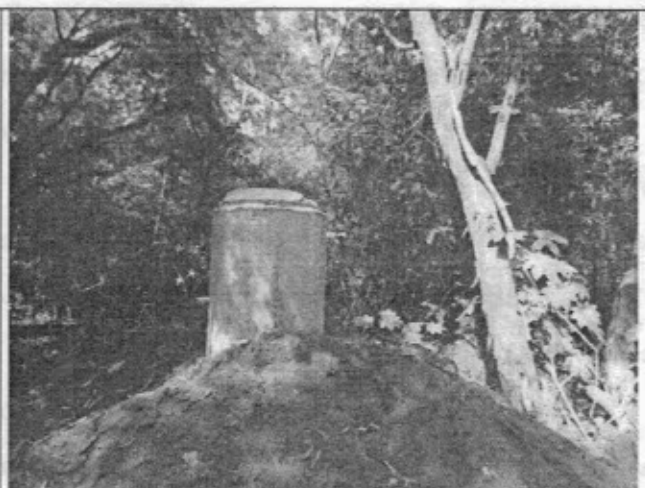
vista de PV da Sanepar que foi reparado após vazamento.
